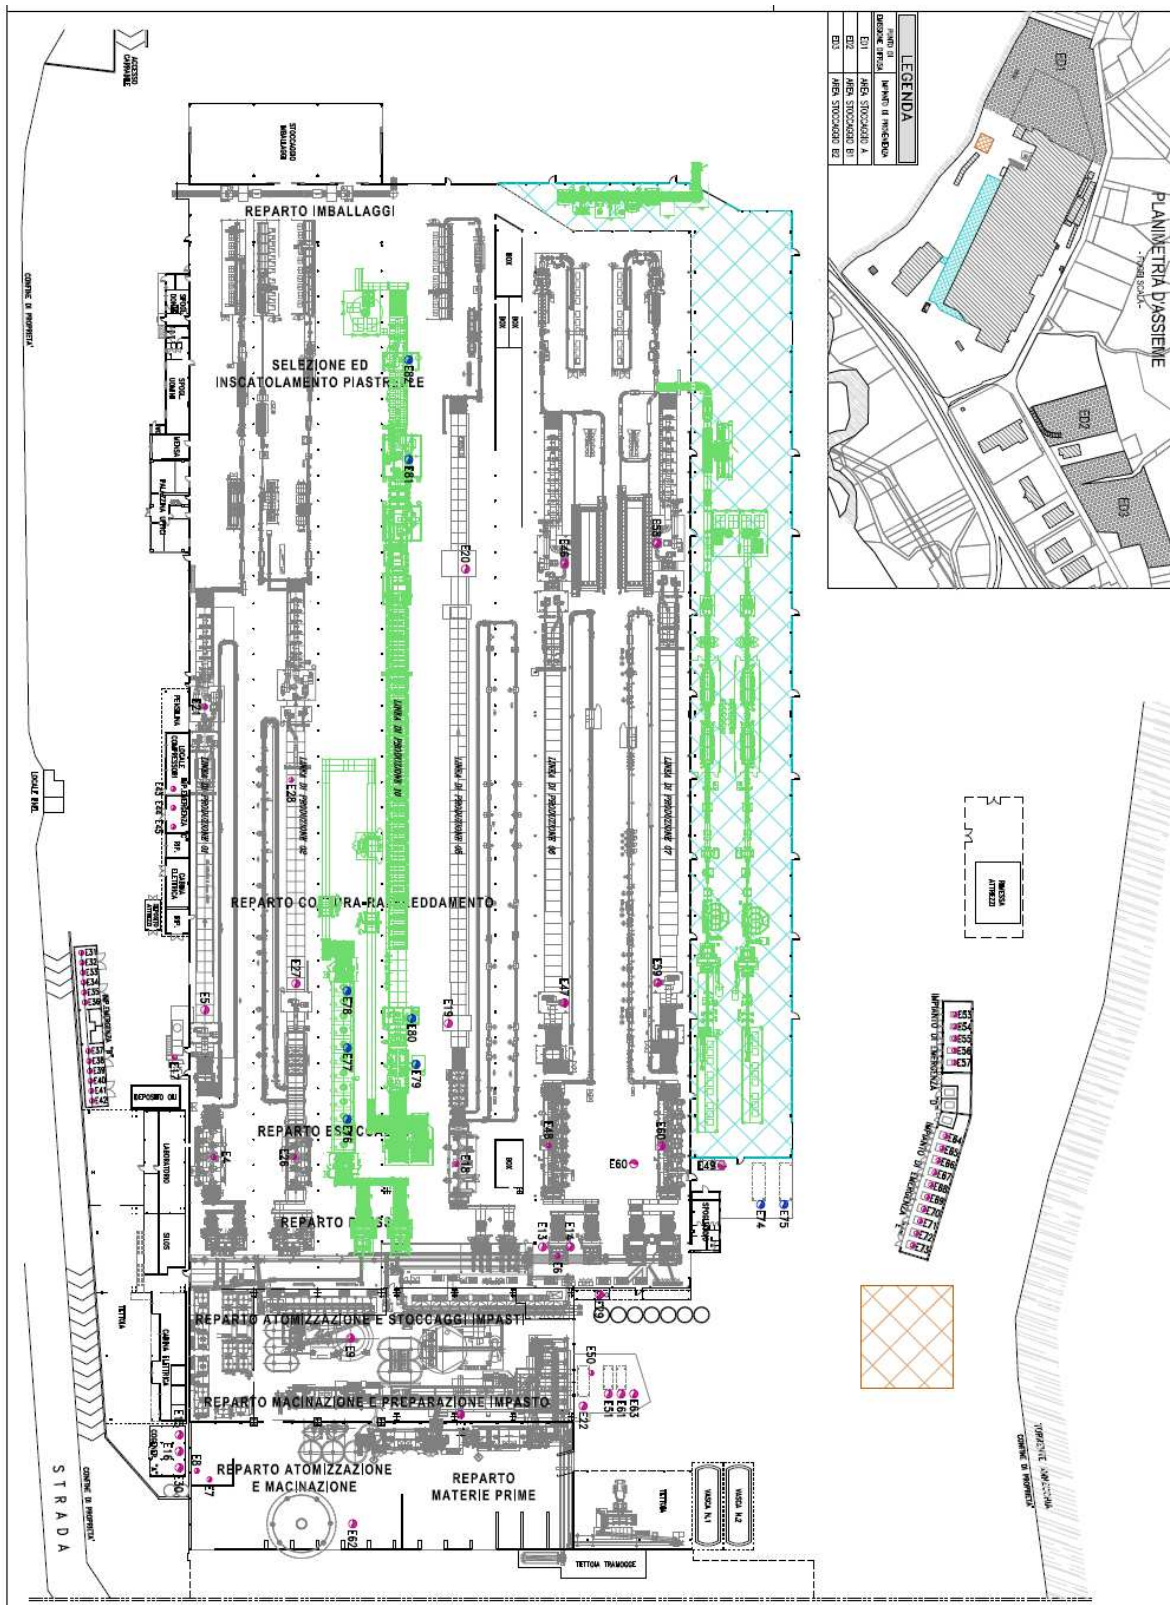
Planimetria con indicazione degli impianti di progetto
